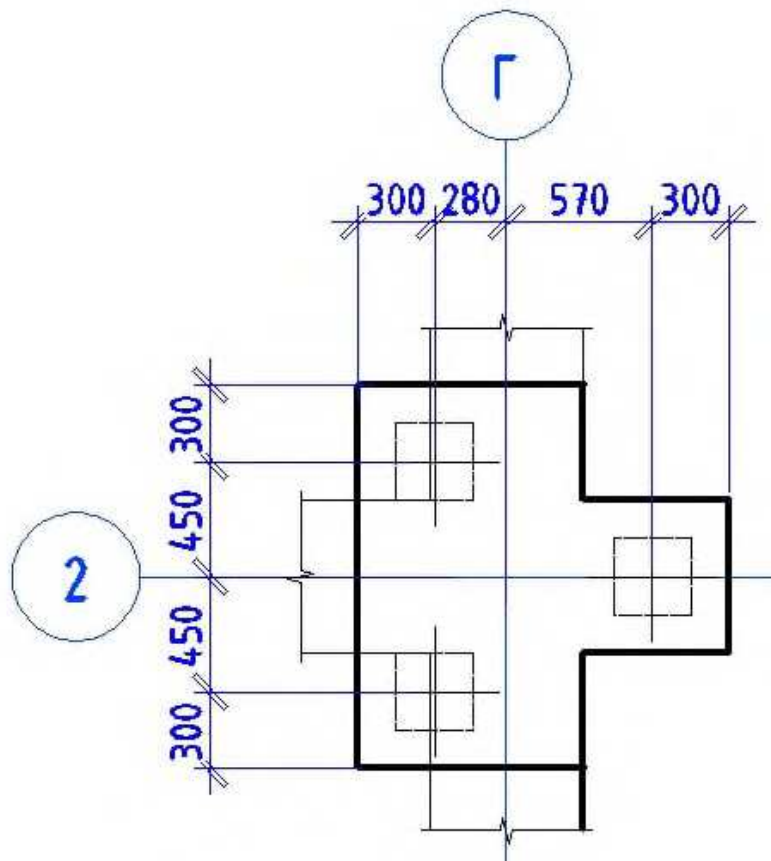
План ростверка Рсм1 со схемой расстановки свай
